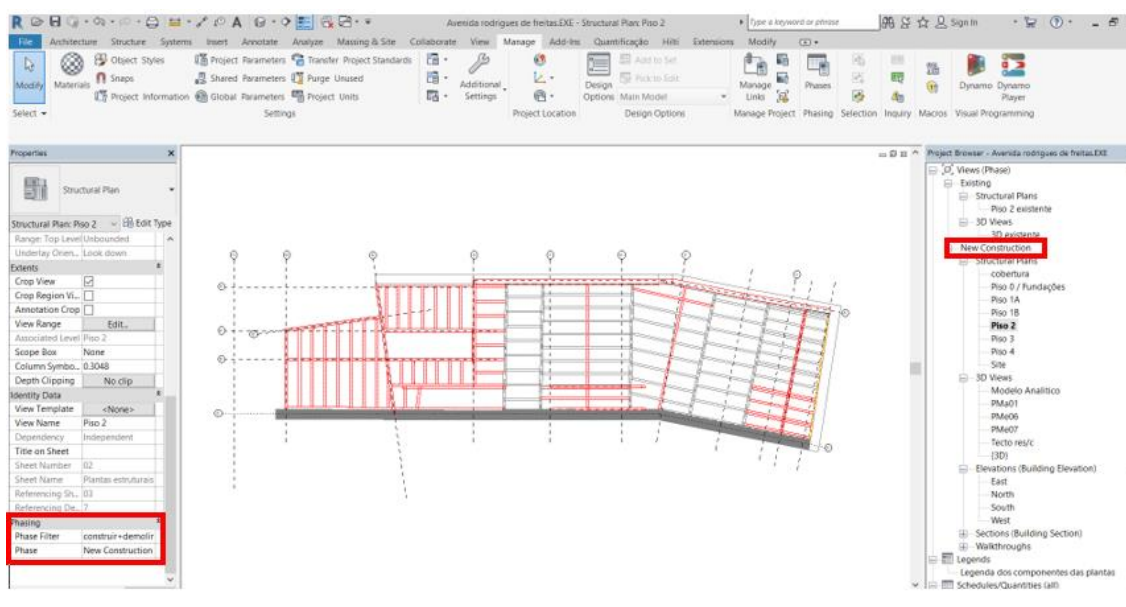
Vista do 2º piso ilustrando os elementos existentes, a demolir e a construir
